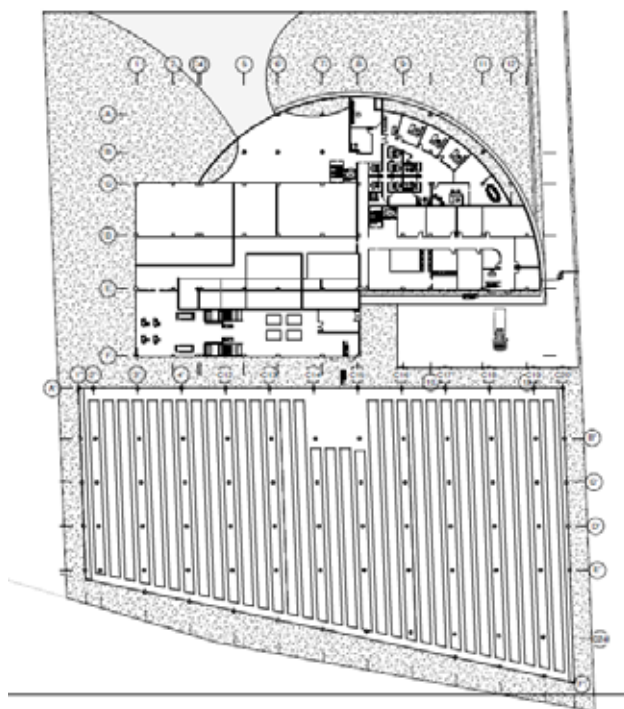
Imagen de Planta Baja conjunto de la Planta Procesadora de Sábila.
